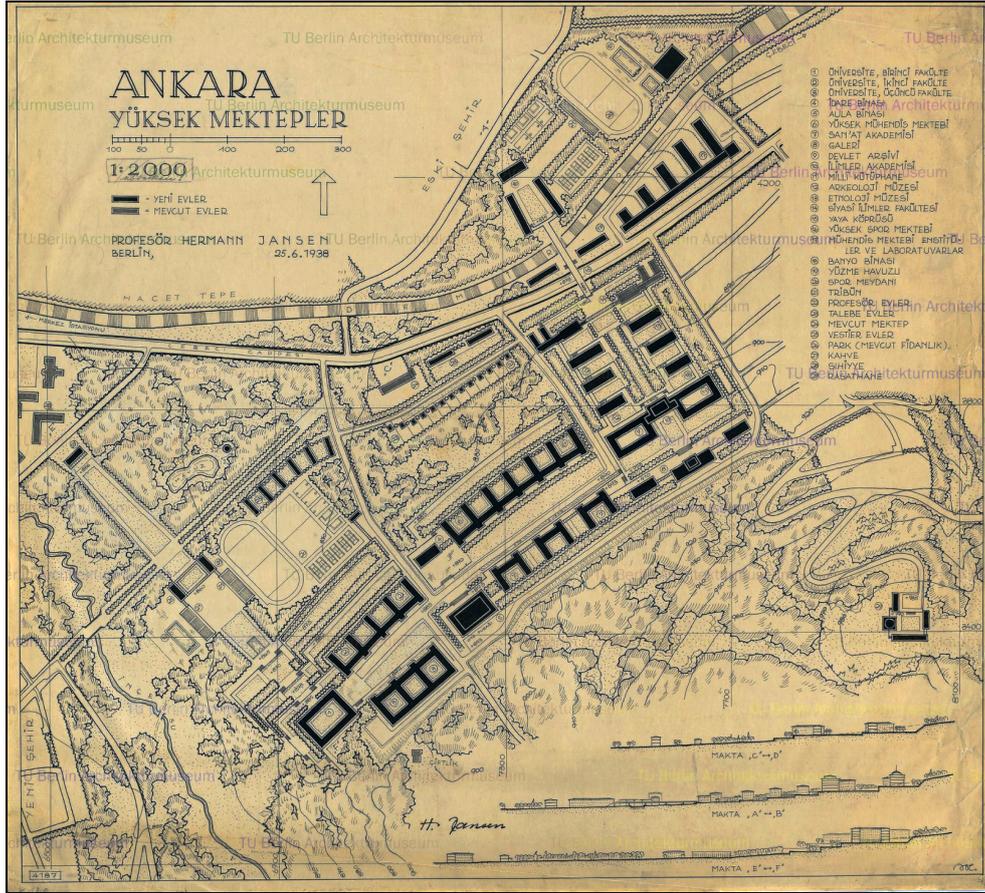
Hermann Jansen, Gesamtbebauungsplan Ankara, Teilbebauungsplan Hochschulviertel, Lageplan, 1938.
